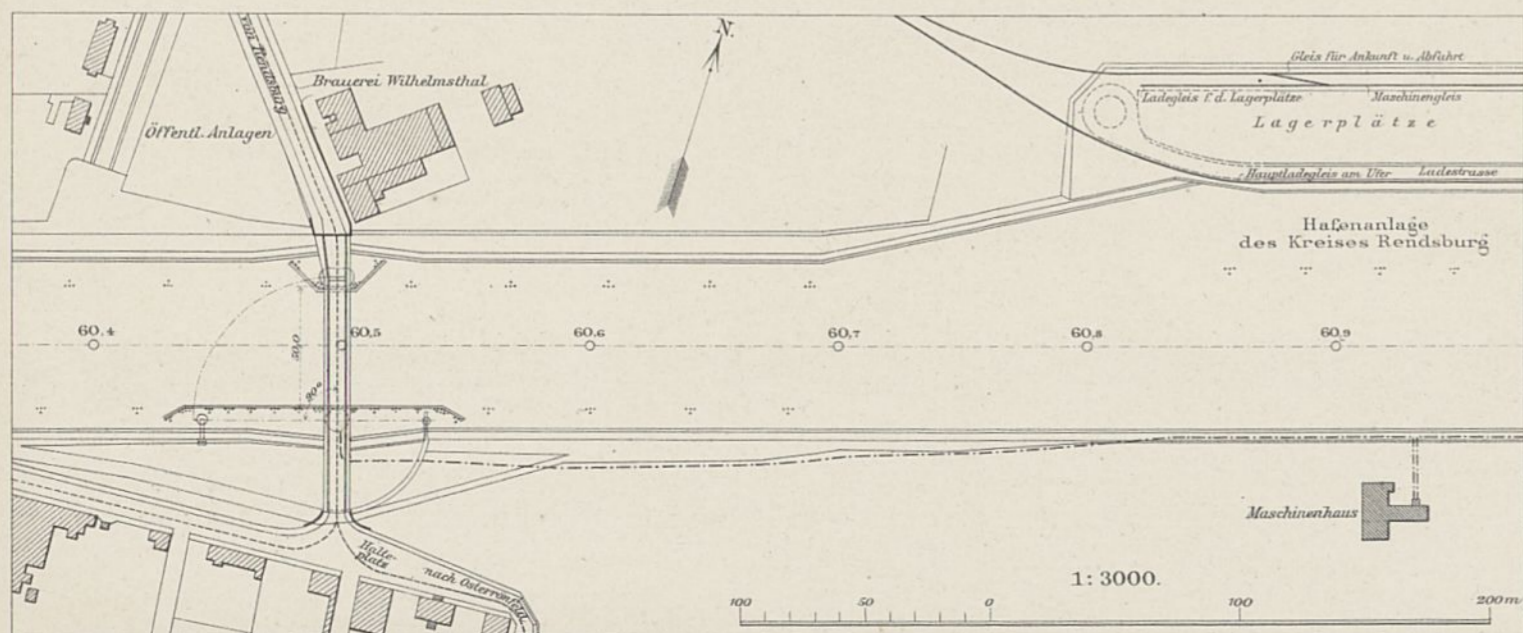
Lageplan der Strassen-Drehbrücke bei Rendsburg. 1:3000.
